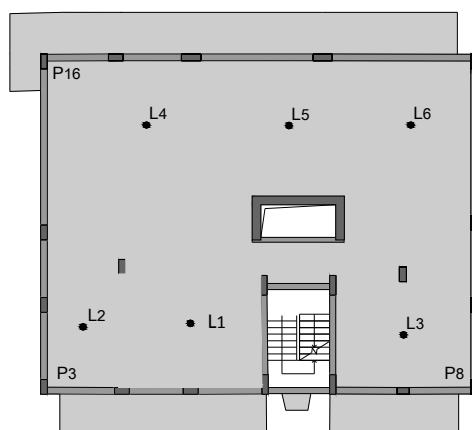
Plantas estruturais do piso tipo do edifício 3
